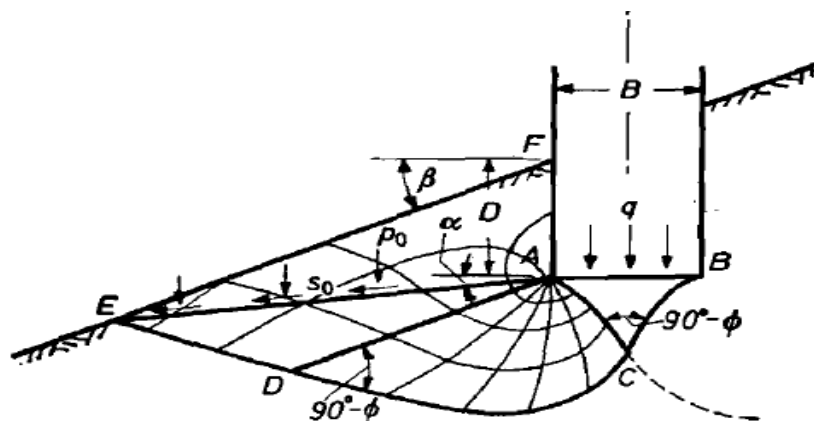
Surface de rupture d'une fondation filante rugueuse située sur une pente d'après Meyerhof (1957)
